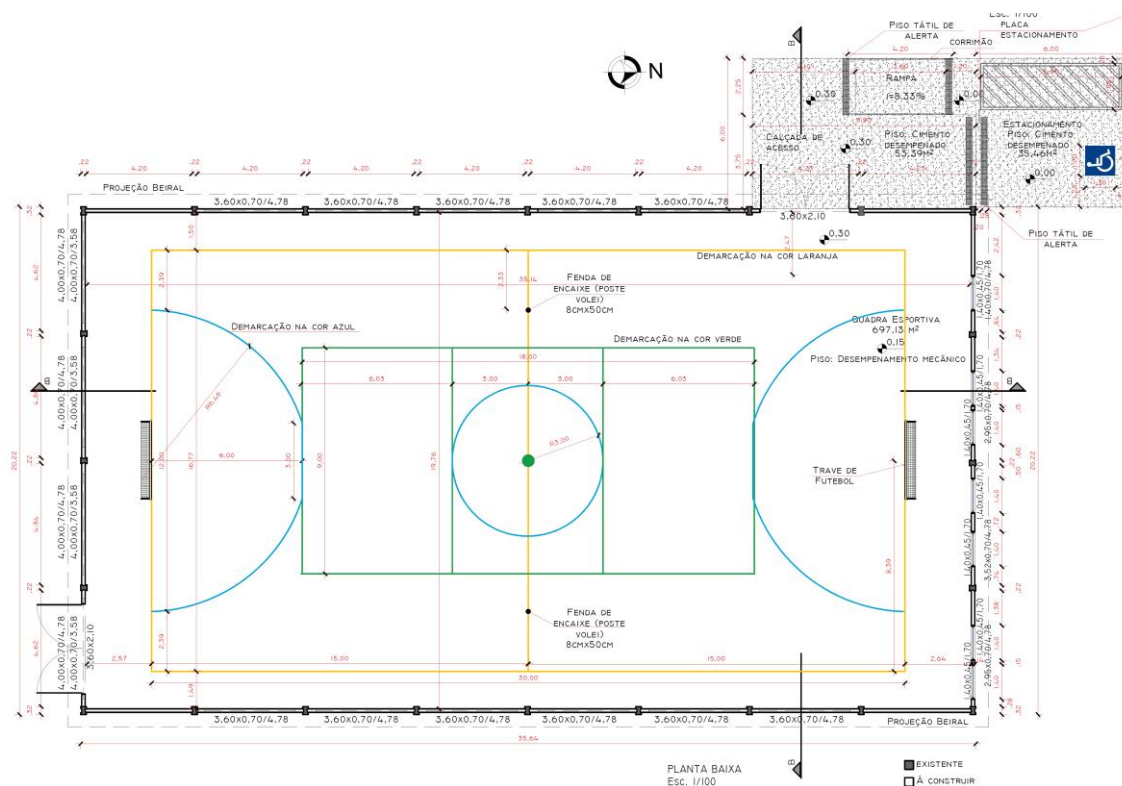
Planta baixa, com modificações preteridas para o empreendimento.
